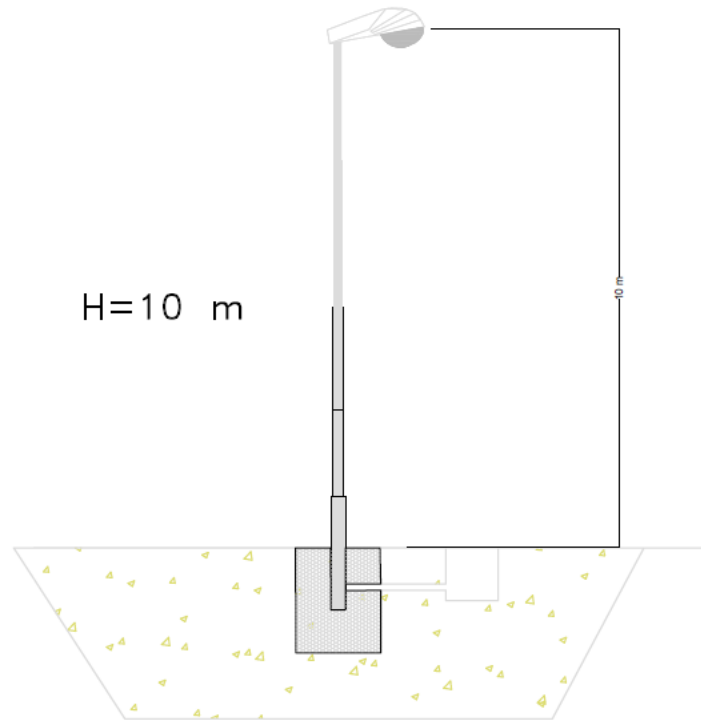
Particolare palina di illuminazione in progetto per la Stazione di Elevazione
